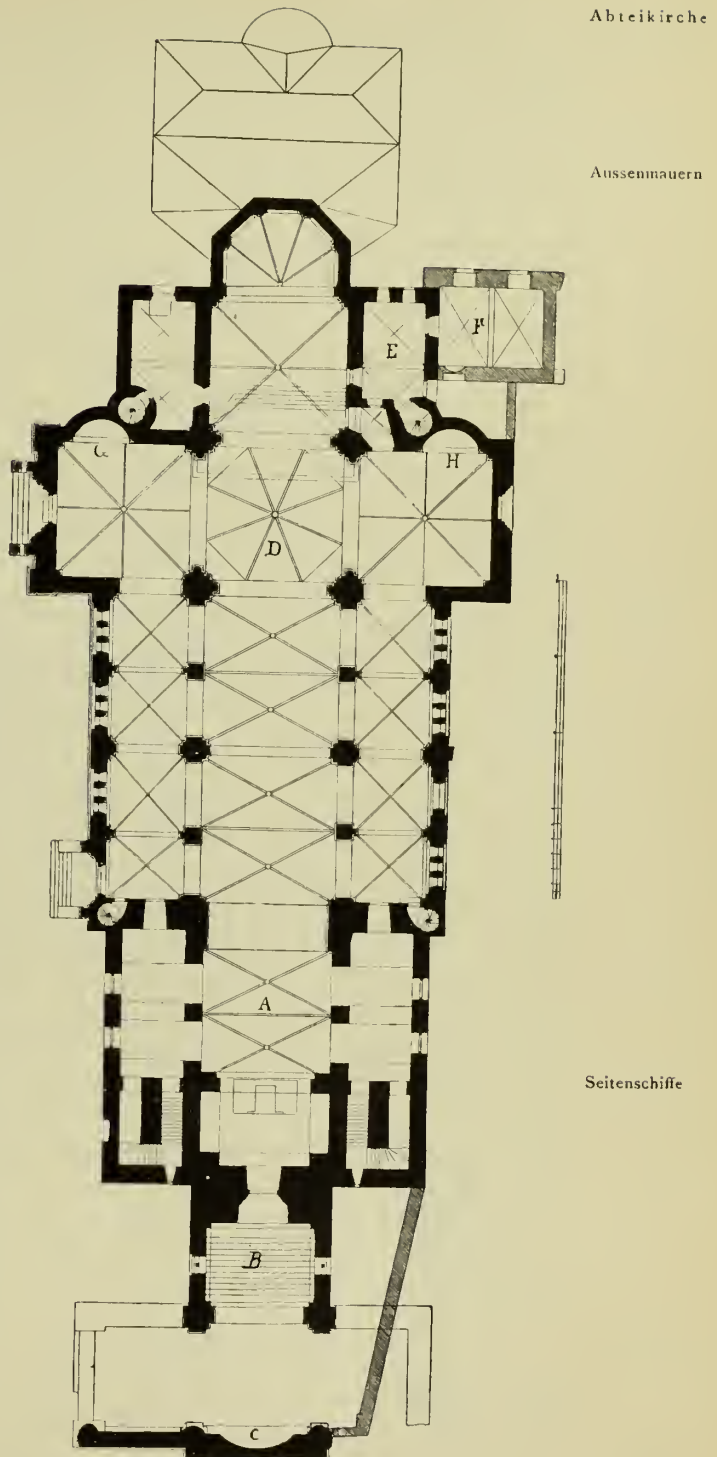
Werden. Grundriss der Abteikirche.
